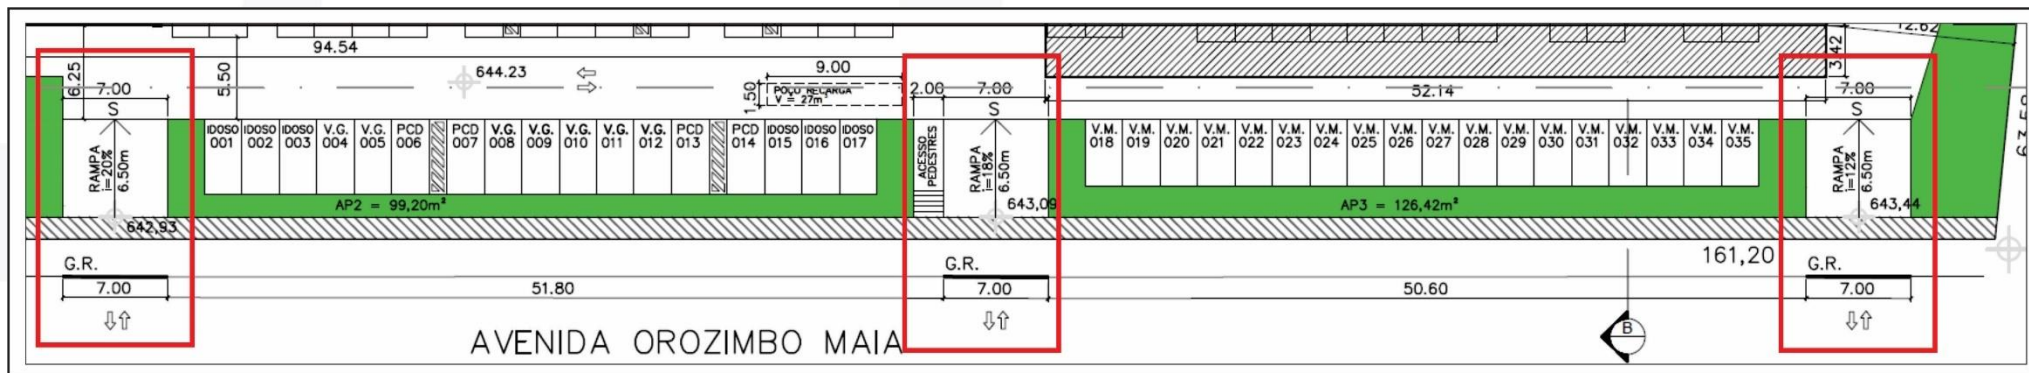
Projeto Simplificado – Implantação 6º Pavimento
